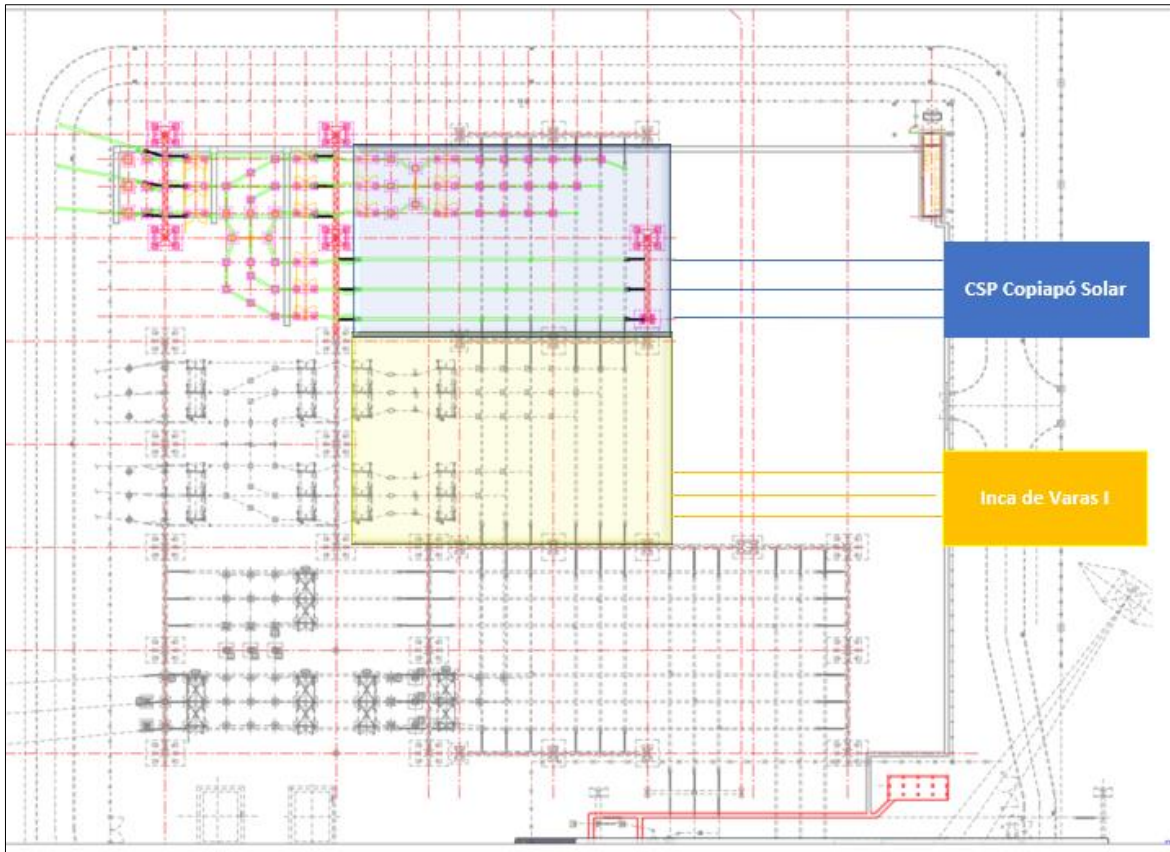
Plano de Planta S/E Carrera Pinto 220 kV.
